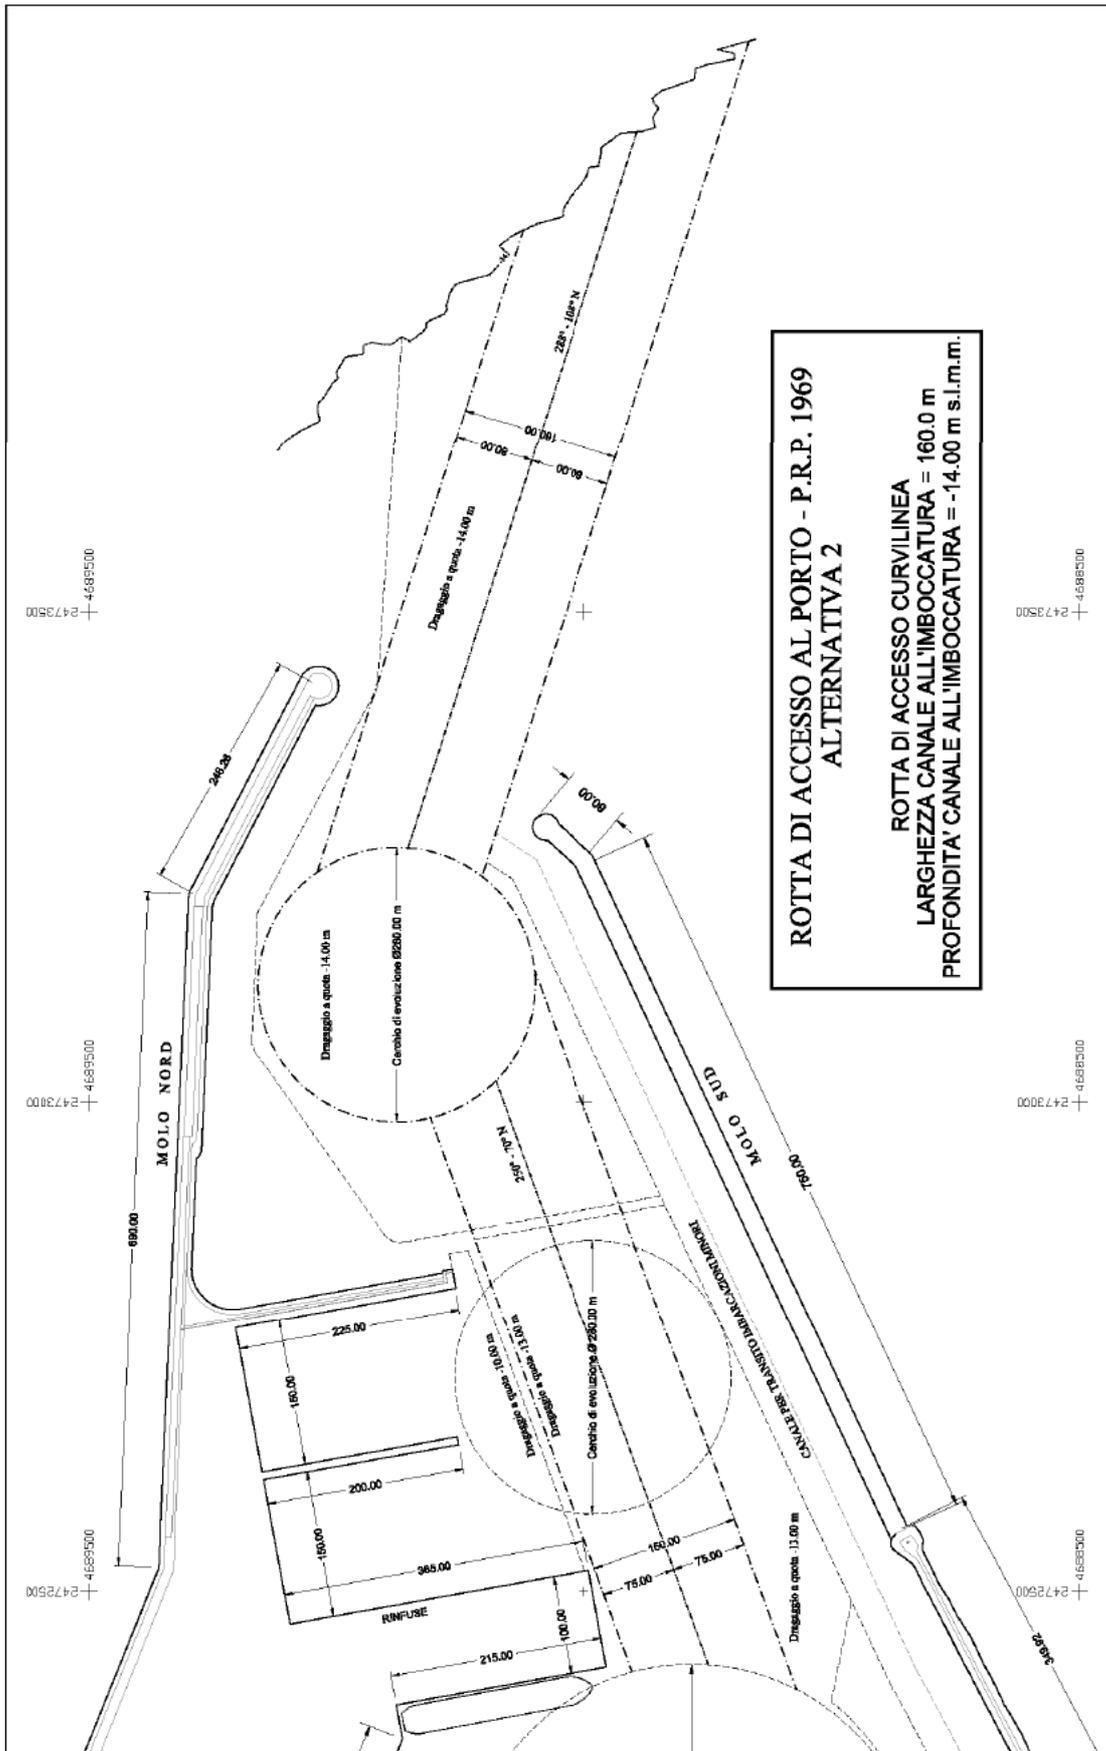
Canale di accesso al porto previsto dalla configurazione vigente (PRP 1969) – Alternativa 2.
